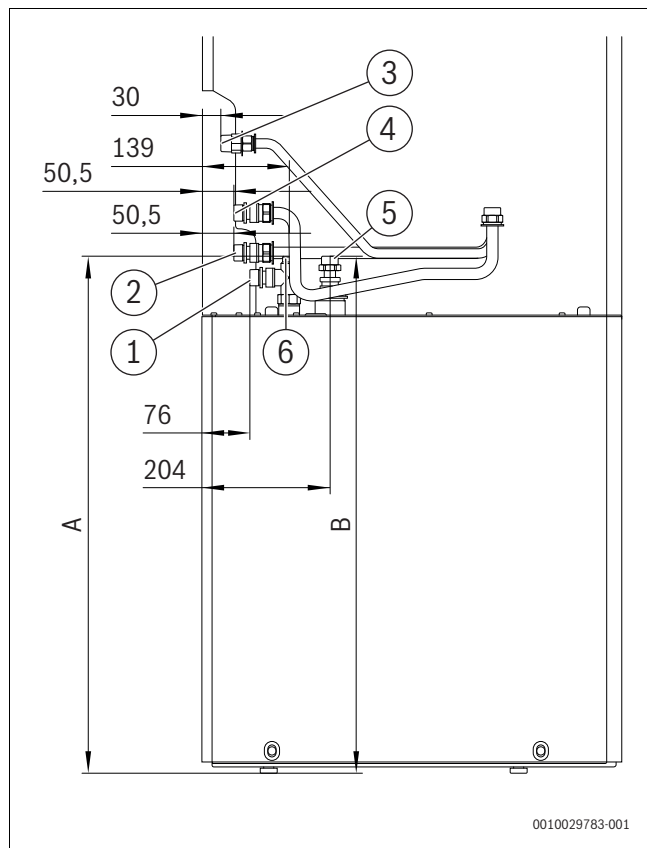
Prikaz sa stražnje strane (dimenzije u mm)
